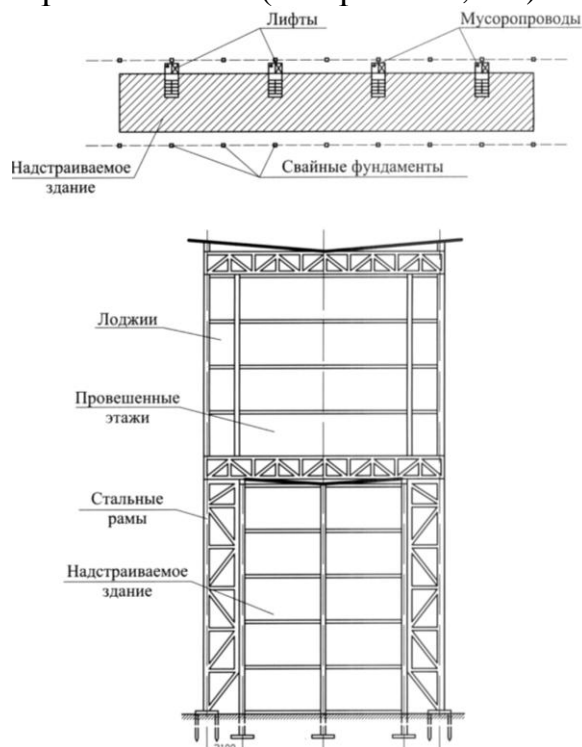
Надстройка здания с опиранием на собственные опоры
